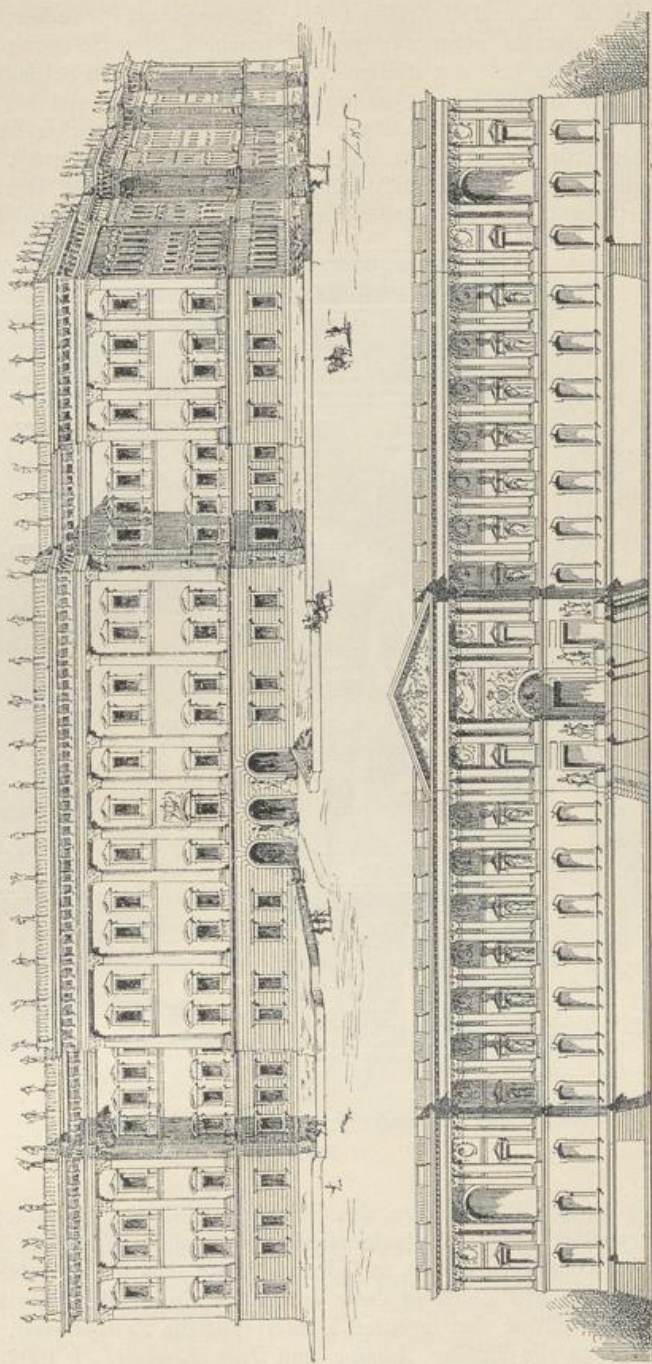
Berninis Plan für die Louvrefassade — Fig. 63 Perraults Plan für die Louvrefassade
